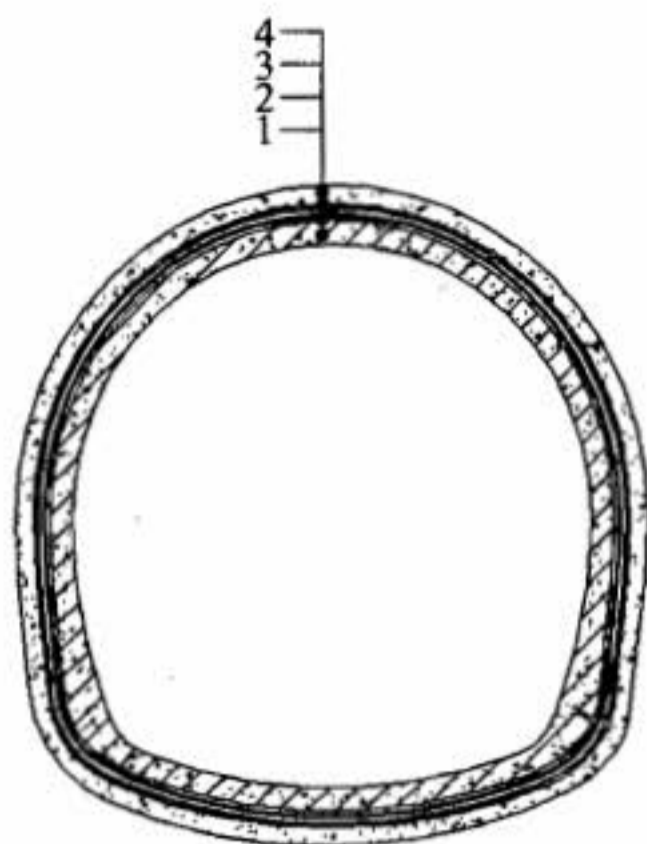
矿山法隧道结构丙酸盐喷膜防水层构造示意
